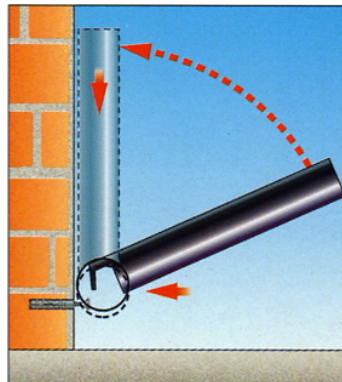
Praticare un foro diametro 6 mm e profondo 40 mm, non inferiore a 40 mm da terra, per facilitare la pulizia del pavimento.
